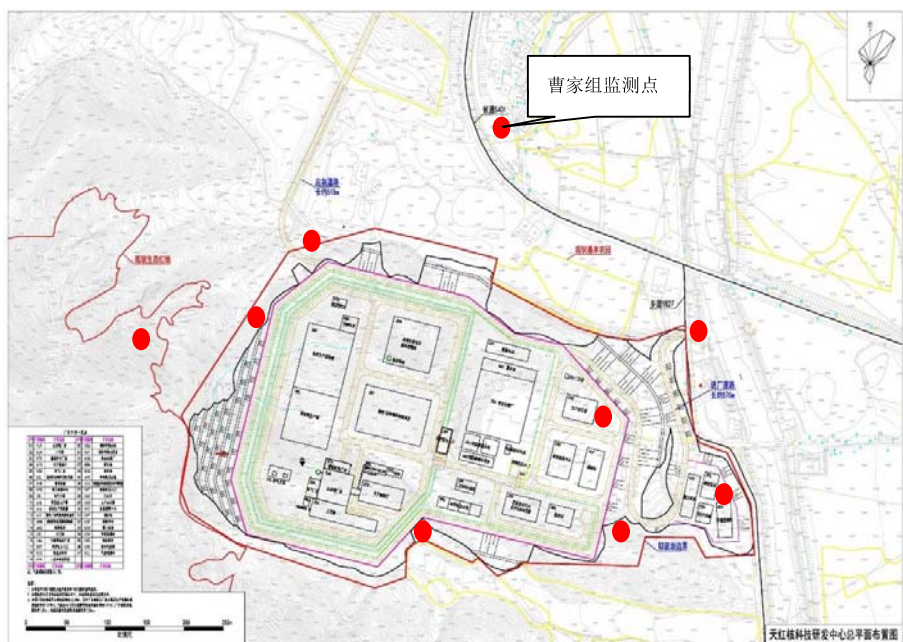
施工建造期大气环境监测点位图（厂区）
